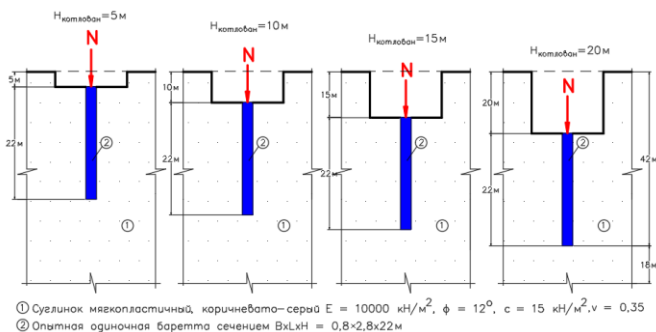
Расчетные схемы барреты при разработке грунта котлована
